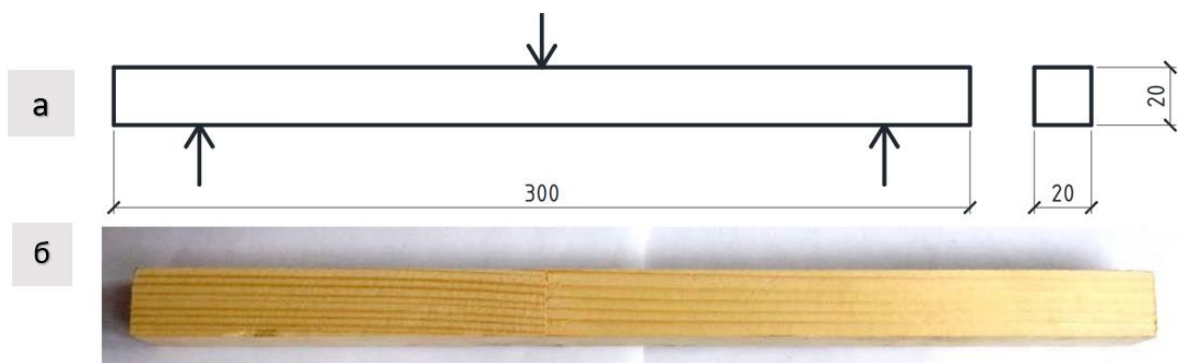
Дослідний зразок для випробування на згин; а) схема зразка; б) загальний вигляд зразка.
